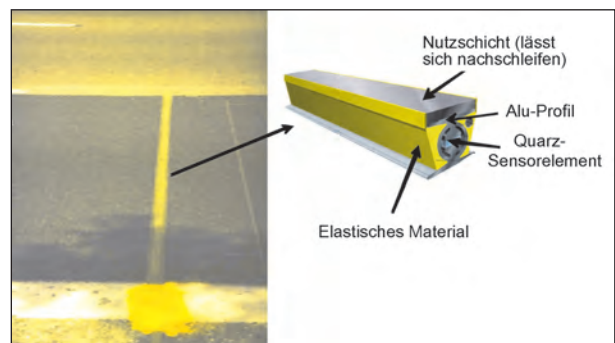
Beispielhafte Darstellung eines in den Hauptfahrstreifen einer BAB eingebauten Piezosensors zur Achslasterfassung
